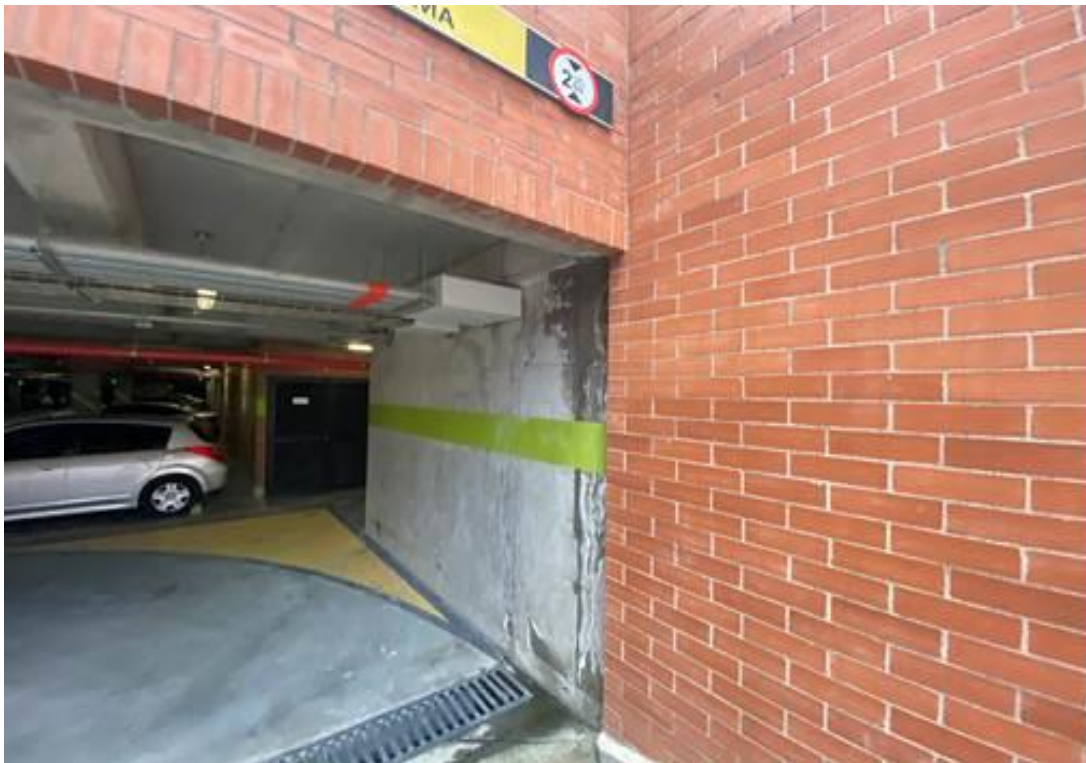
Filtraciones por fisuras muro de contención sótano
